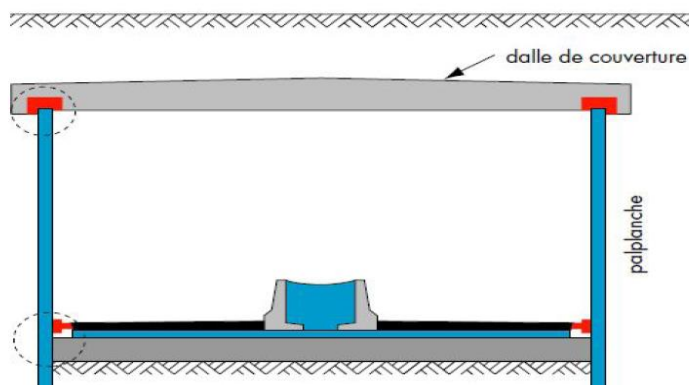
Système d'étanchéité horizontale (cas de tunnel)
